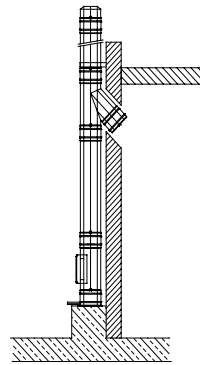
Aufbau mit Grundplatte für Sockelmontage
